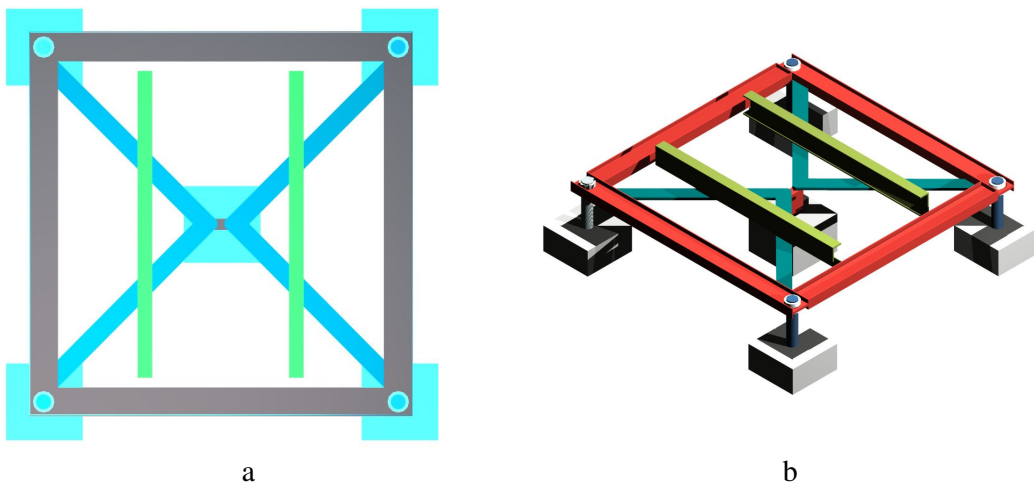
Base de fixação do lisímetro, com a célula de carga no centro da estrutura: (a) vista superior e (b) vista tridimensional.
